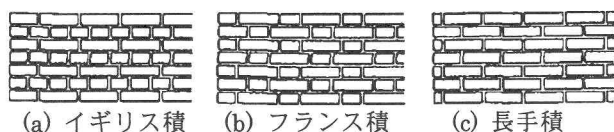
トンネル覆工に用いられる煉瓦積み形式 (Fig.2 Stacked Form of Brick Used in a Tunnel)
